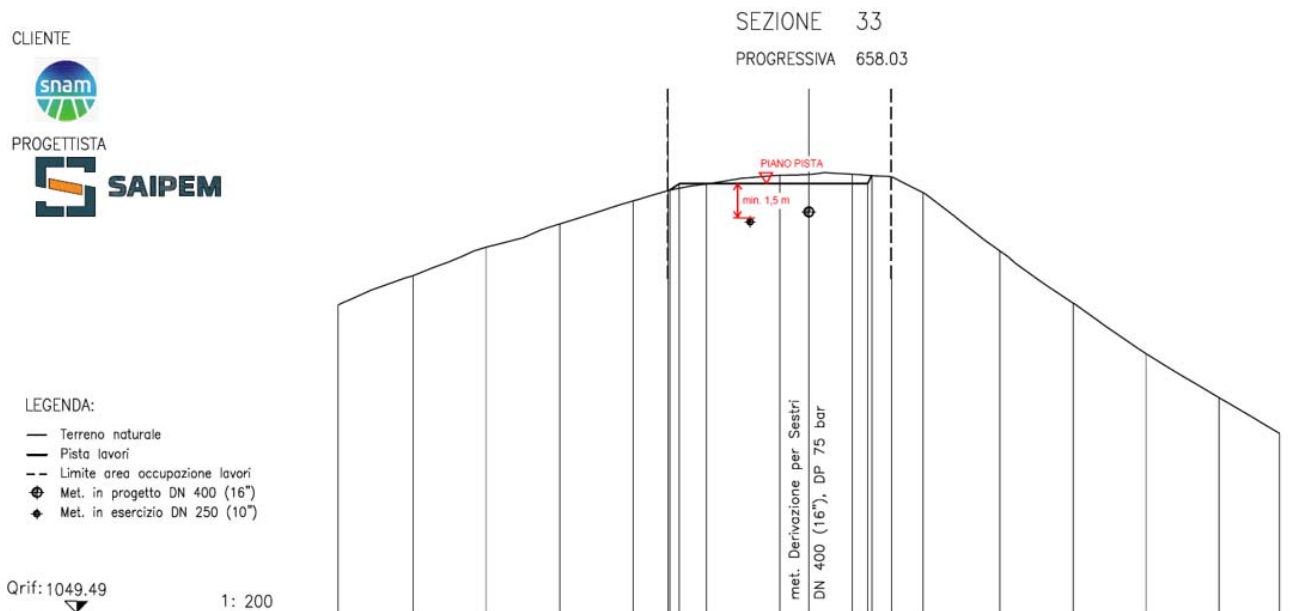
Sezione tipo condotta DN 250 (10") esistente
